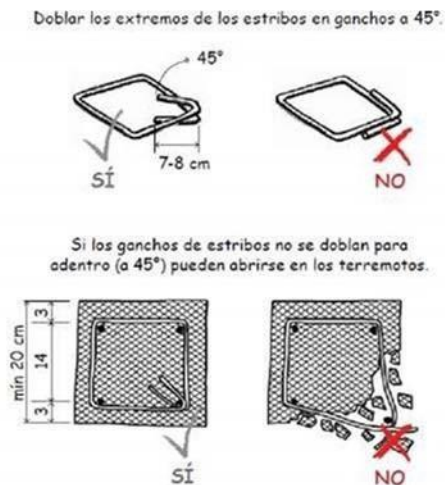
Imagen de la Guía para la construcción de vivienda sismorresistente en mampostería confinada
